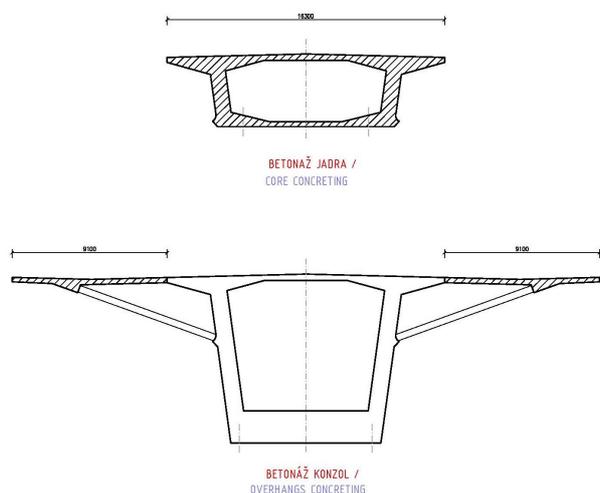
Fases de construcción de la sección tipo del tablero. Arriba se define el cajón central del tablero de 16.3m de ancho, y abajo se definen los voladizos de 9.1m de ancho.
